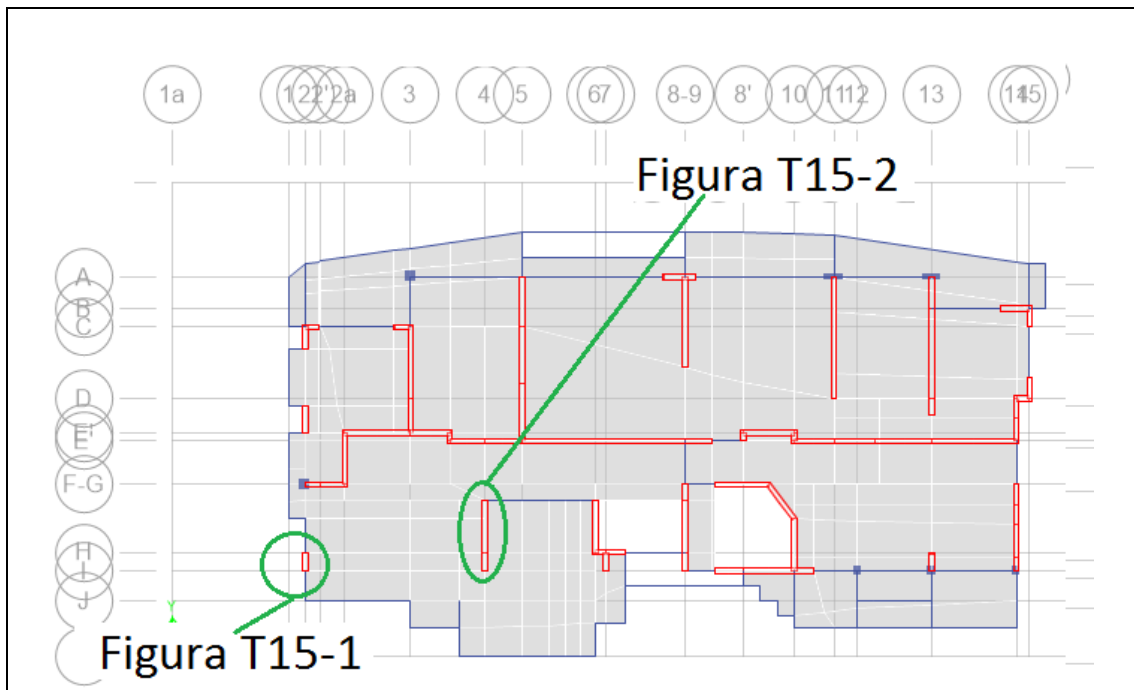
Planta del piso 1 del edificio T15, se indican los elementos dañados
